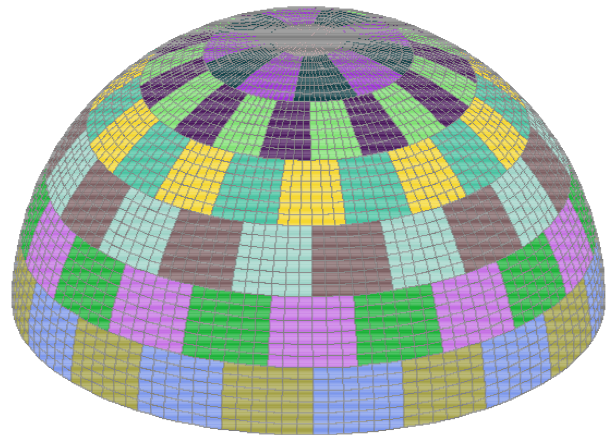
Схема разбивки конструкции опалубки на модульные составные элементы
